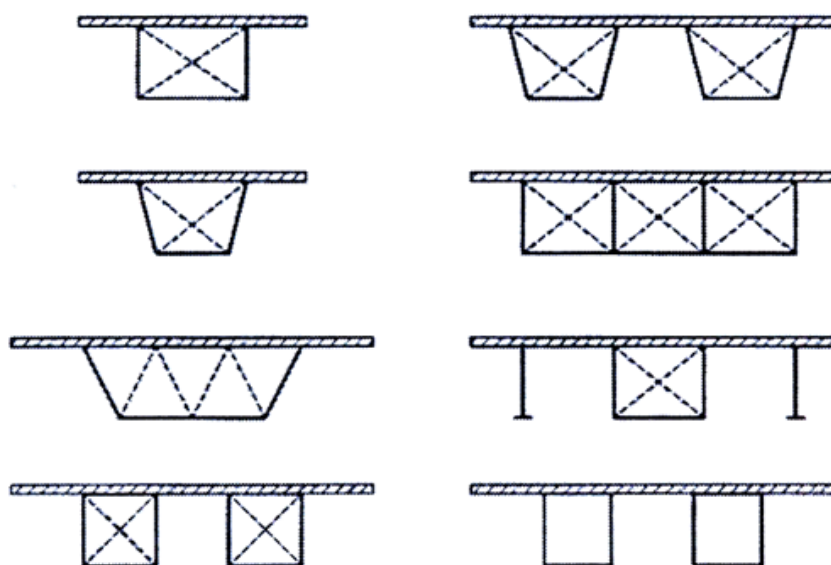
Сталежелезобетонные пролетные строения со стальными конструкциями коробчатого сечения [7]
